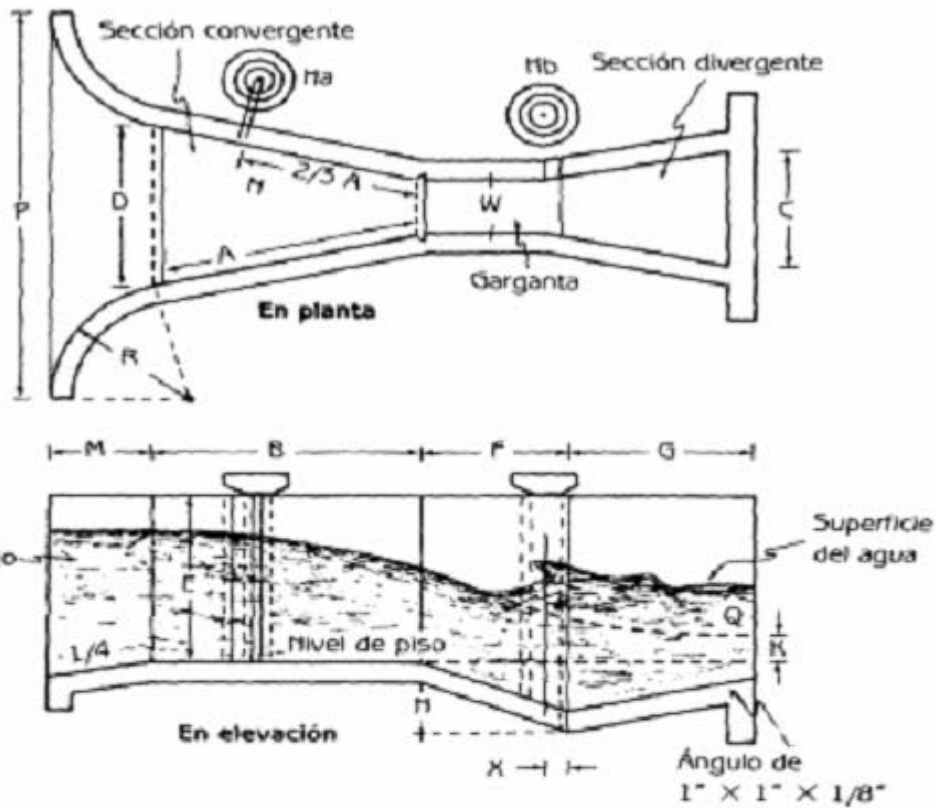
Canaleta de medición Parshall en planta y elevación, mostrando sus dimensiones con letras.
